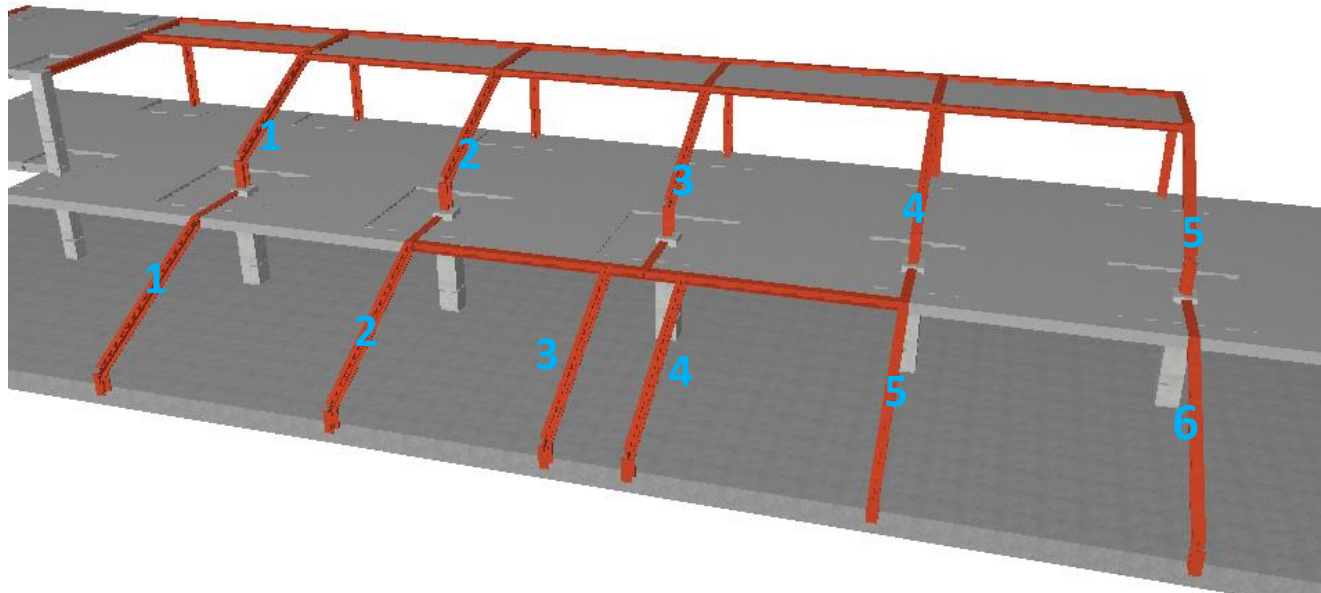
Numeración vigas inclinadas. Fuente: Propia
